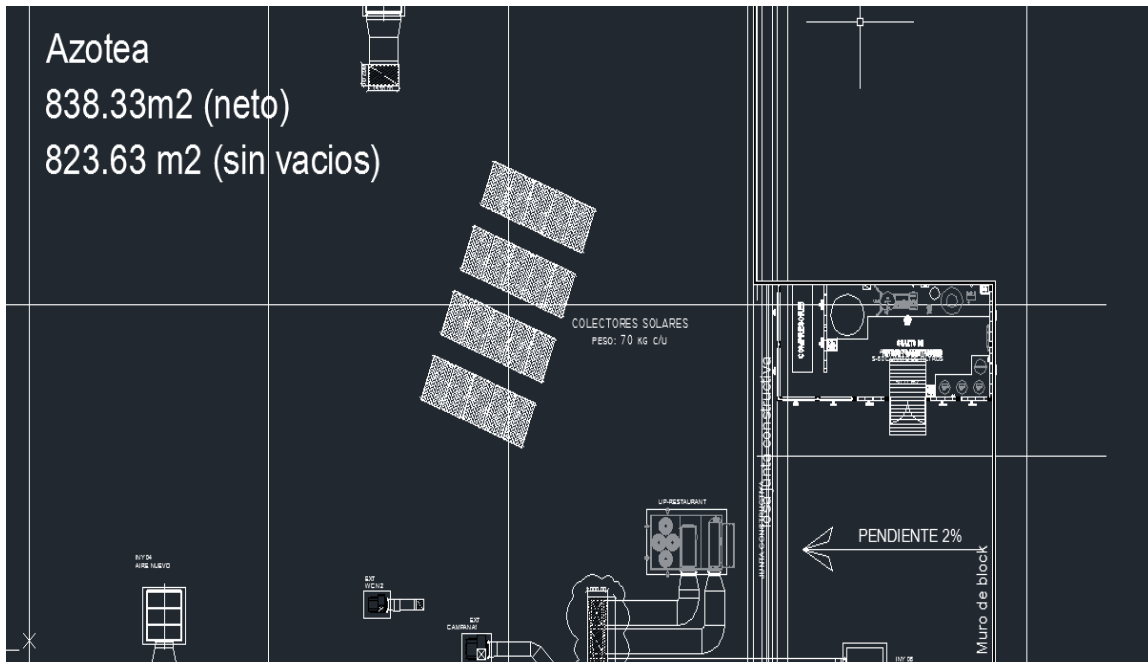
Plano de planta de los equipos para el calentamiento de agua.
